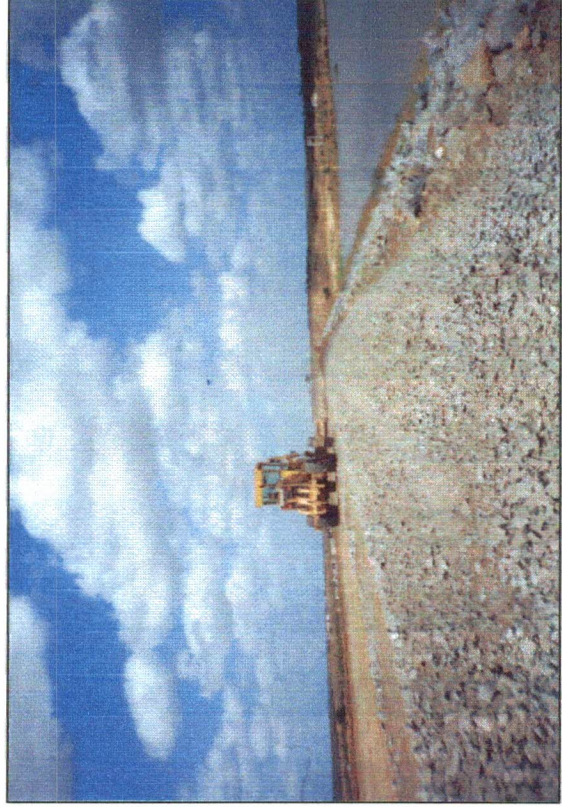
Detalhe da brita de transição do rip-rap após espalhamento.
